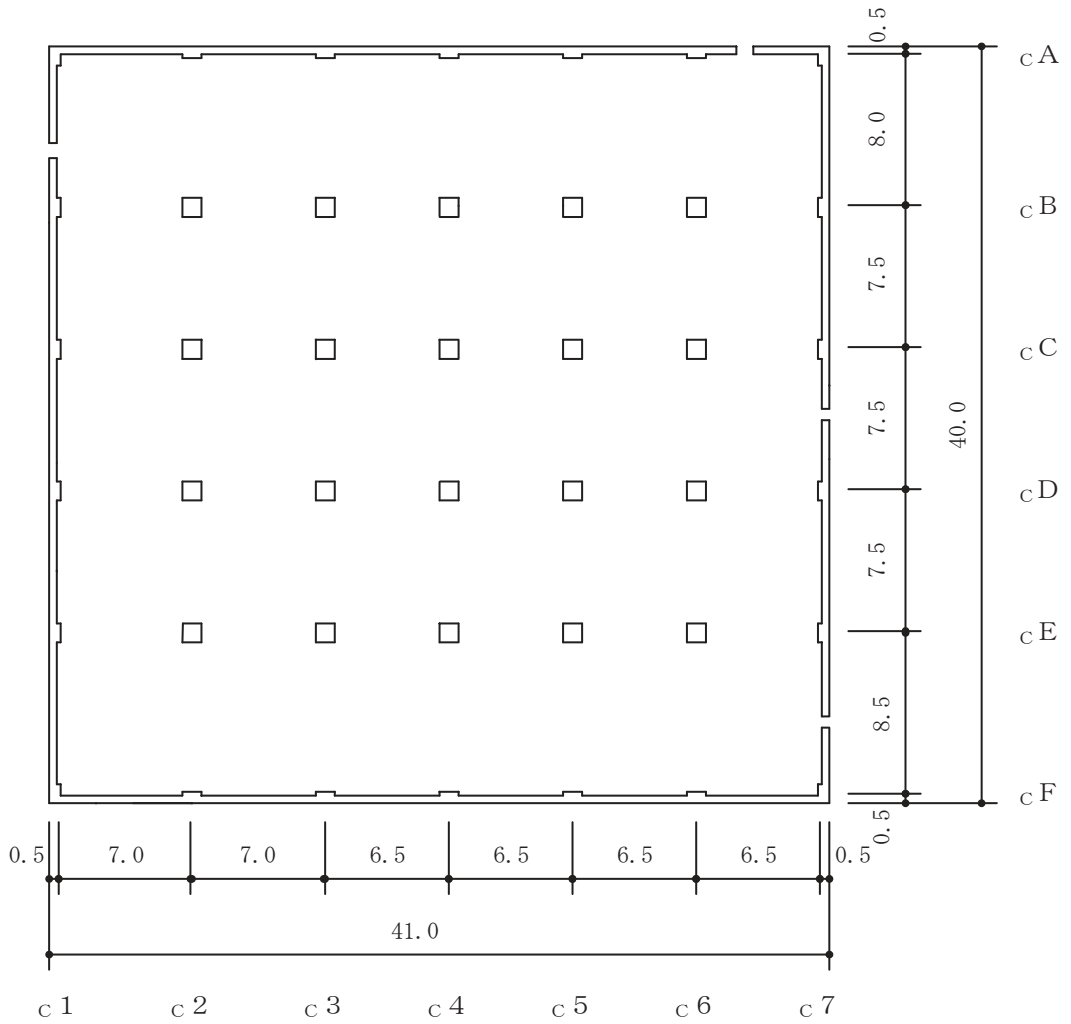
(2) 制御建屋の概略平面図 (O.P. 8.0m)
